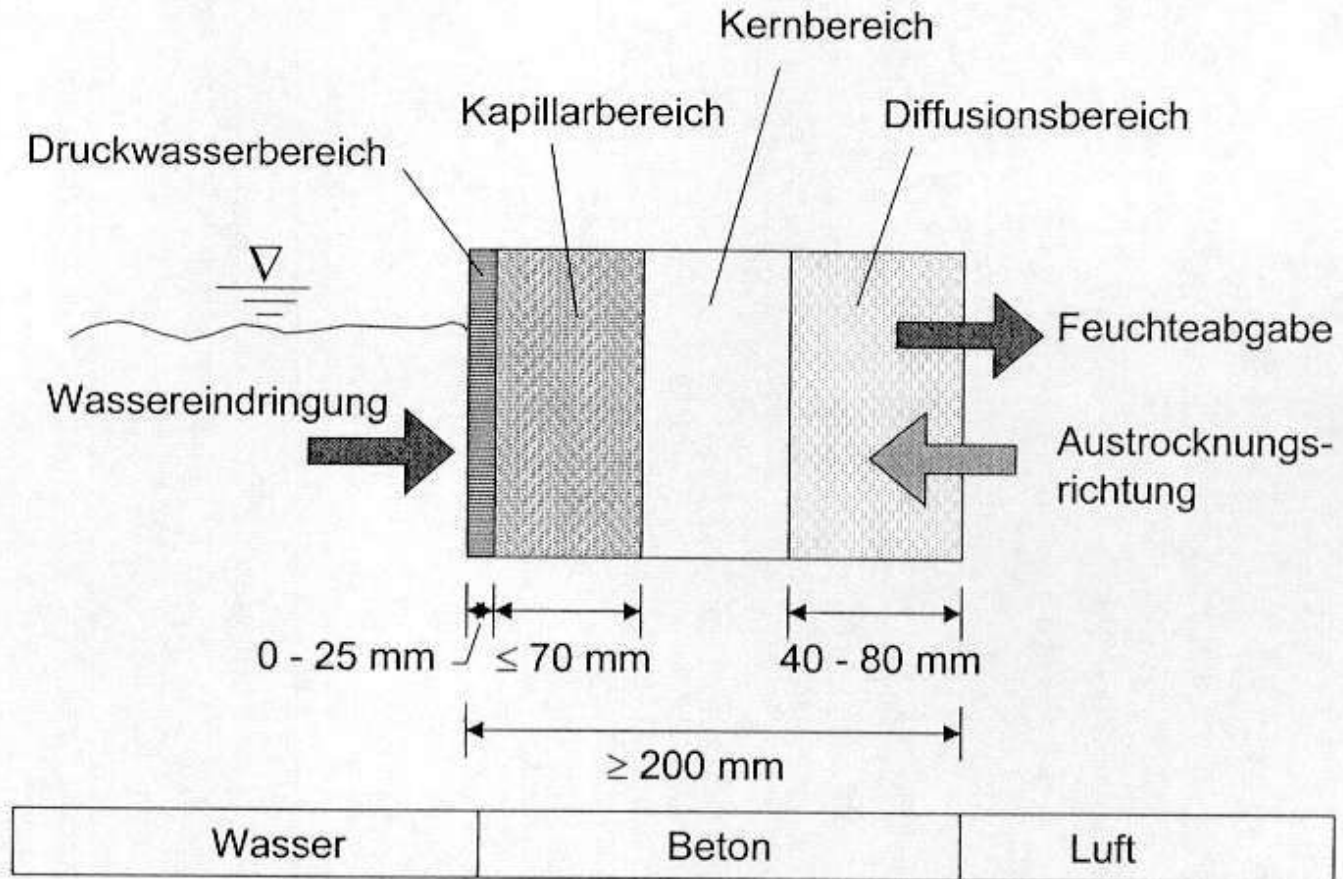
Arbeitsmodell (in Anlehnung an [1.2, 1.3]) für Feuchtebedingungen in einem Betonbauteil-Querschnitt unter einseitiger Beaufschlagung mit drückendem Wasser (Beton B35 WU, $w/z \leq 0,55$)
